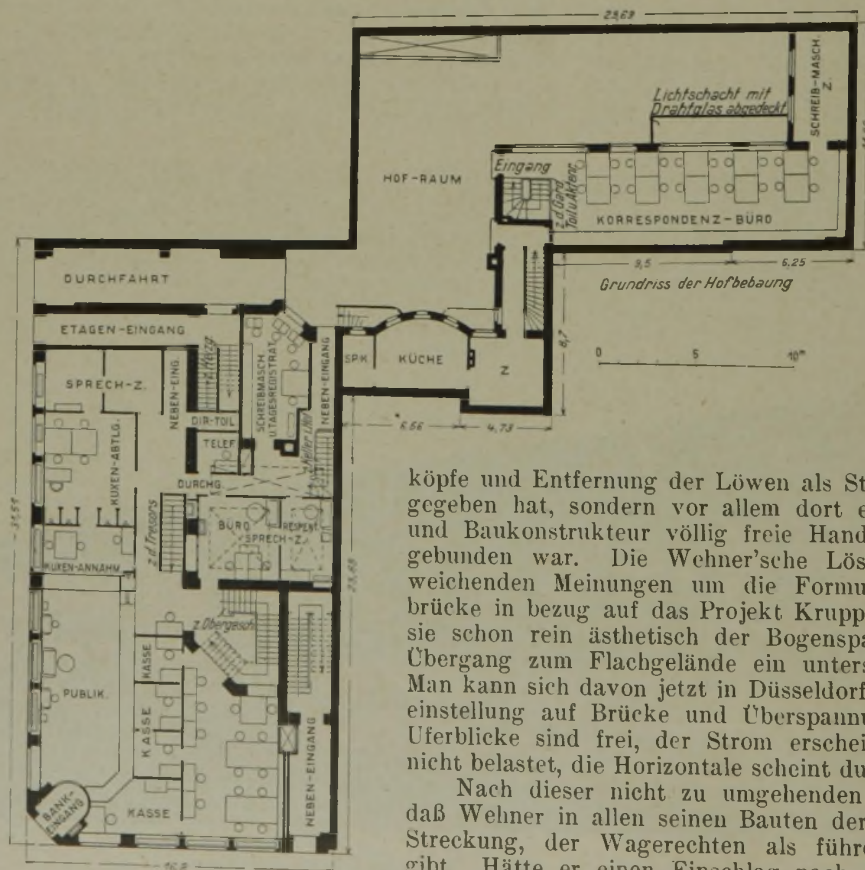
(links). Erdgeschoß-Grundriß für den Umbau der Commerz- u. Privat-Bank in Düsseldorf, Königsallee 70.
